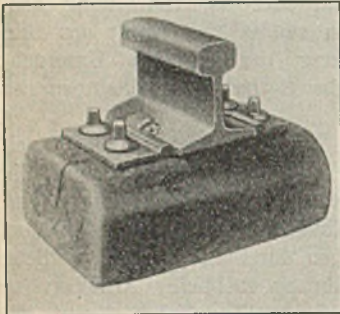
Geschweißte Schienenverbindung mit Sicherheitshaken auf Holzschwelle.
